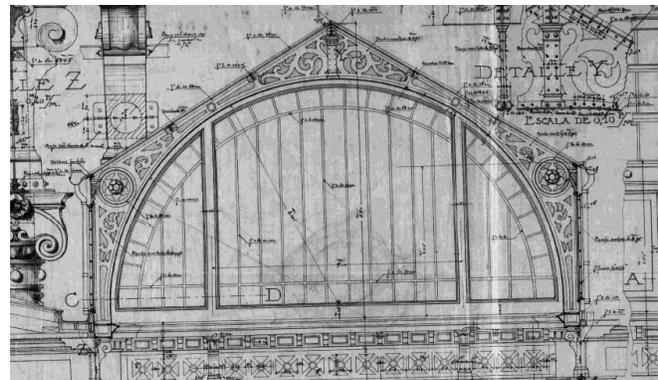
Detalle armadura metálica Sala Pas Perdus. Fuente: Archivo DEPA MOP
